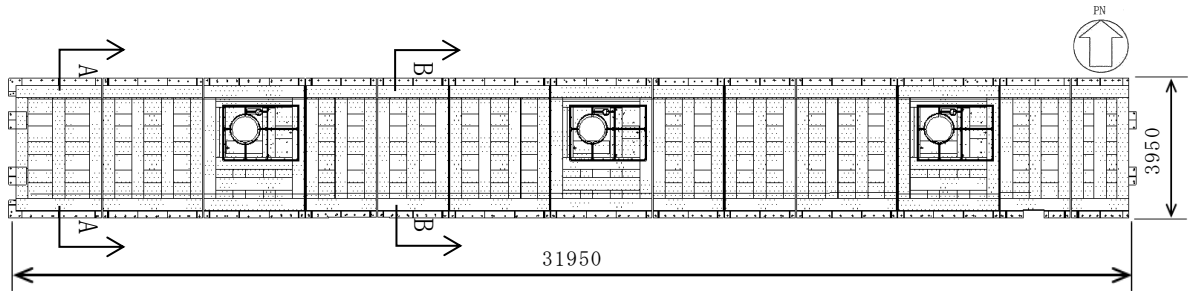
取水槽循環水ポンプエリア防護対策設備の概略平面図 (単位:mm)
